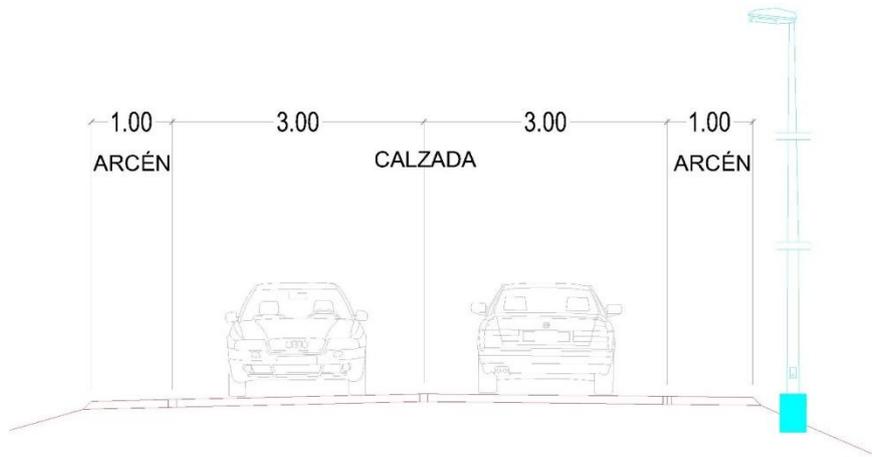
Sección actual Carretera del Grau entre la avenida Unión Europea y la avenida Vicente Cañada Blanch.
